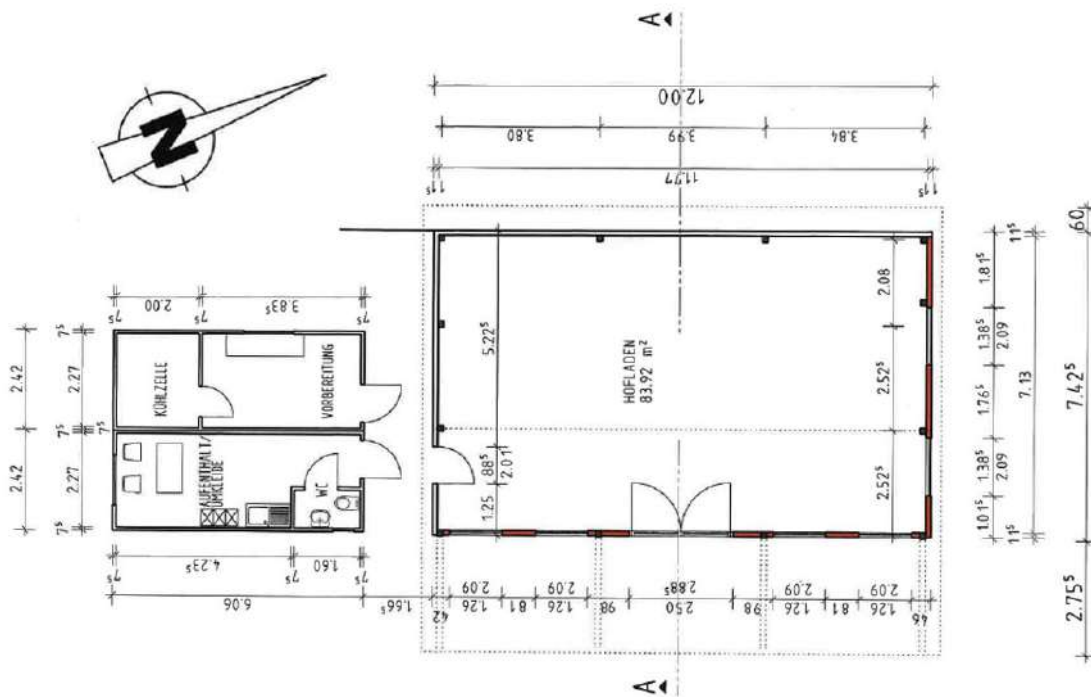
Ausschnitt des Grundrisses aus den Planungsunterlagen des Bauvorhabens (Quelle: Planungs- und Ingenieurbüro Jörg Holst, bereitgestellt durch den Auftraggeber)
